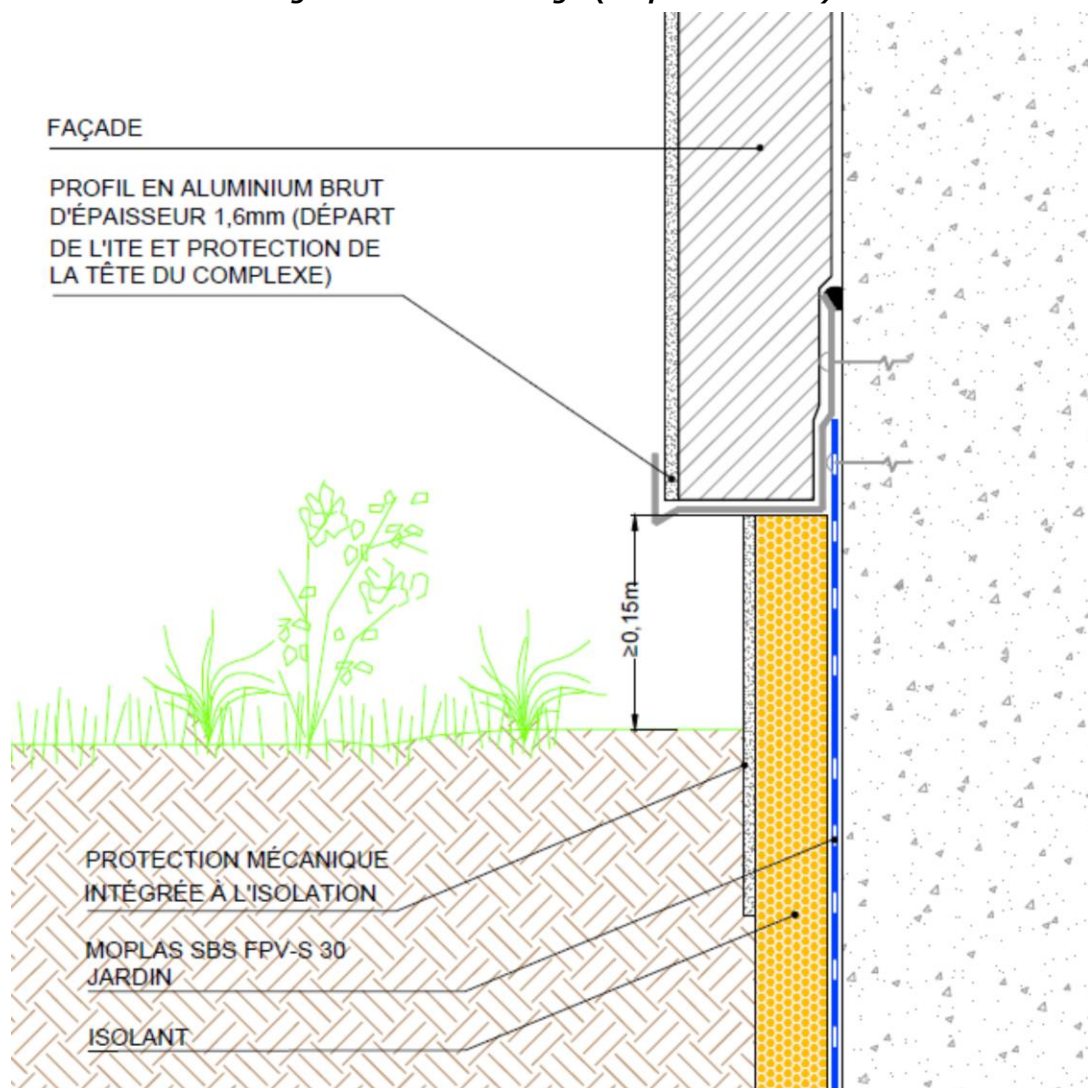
Protection par panneaux XPS et jonction avec la façade en ITE
